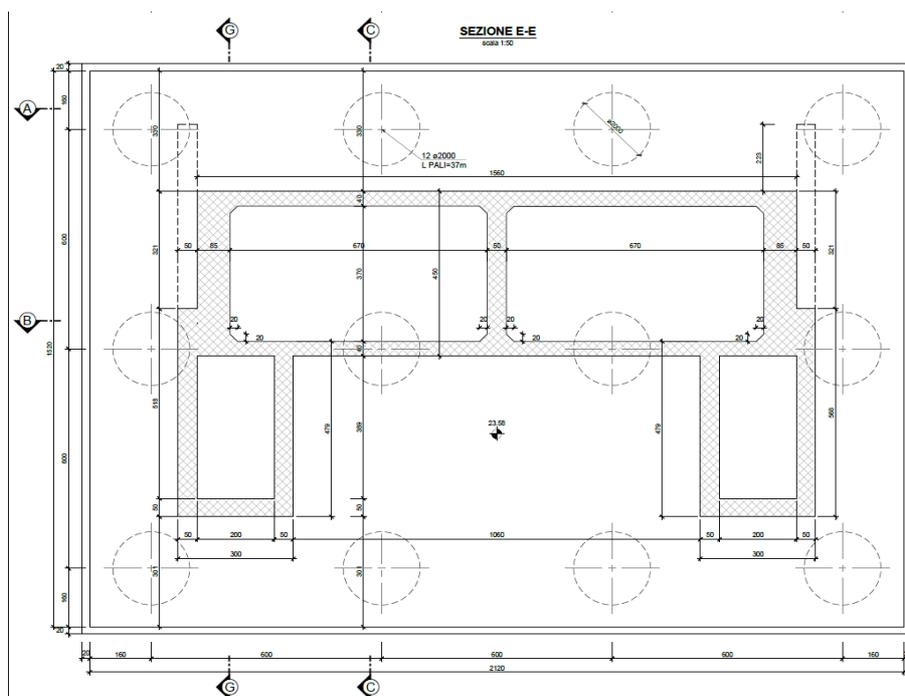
Pila P.27 VI.02 – pianta fondazioni
